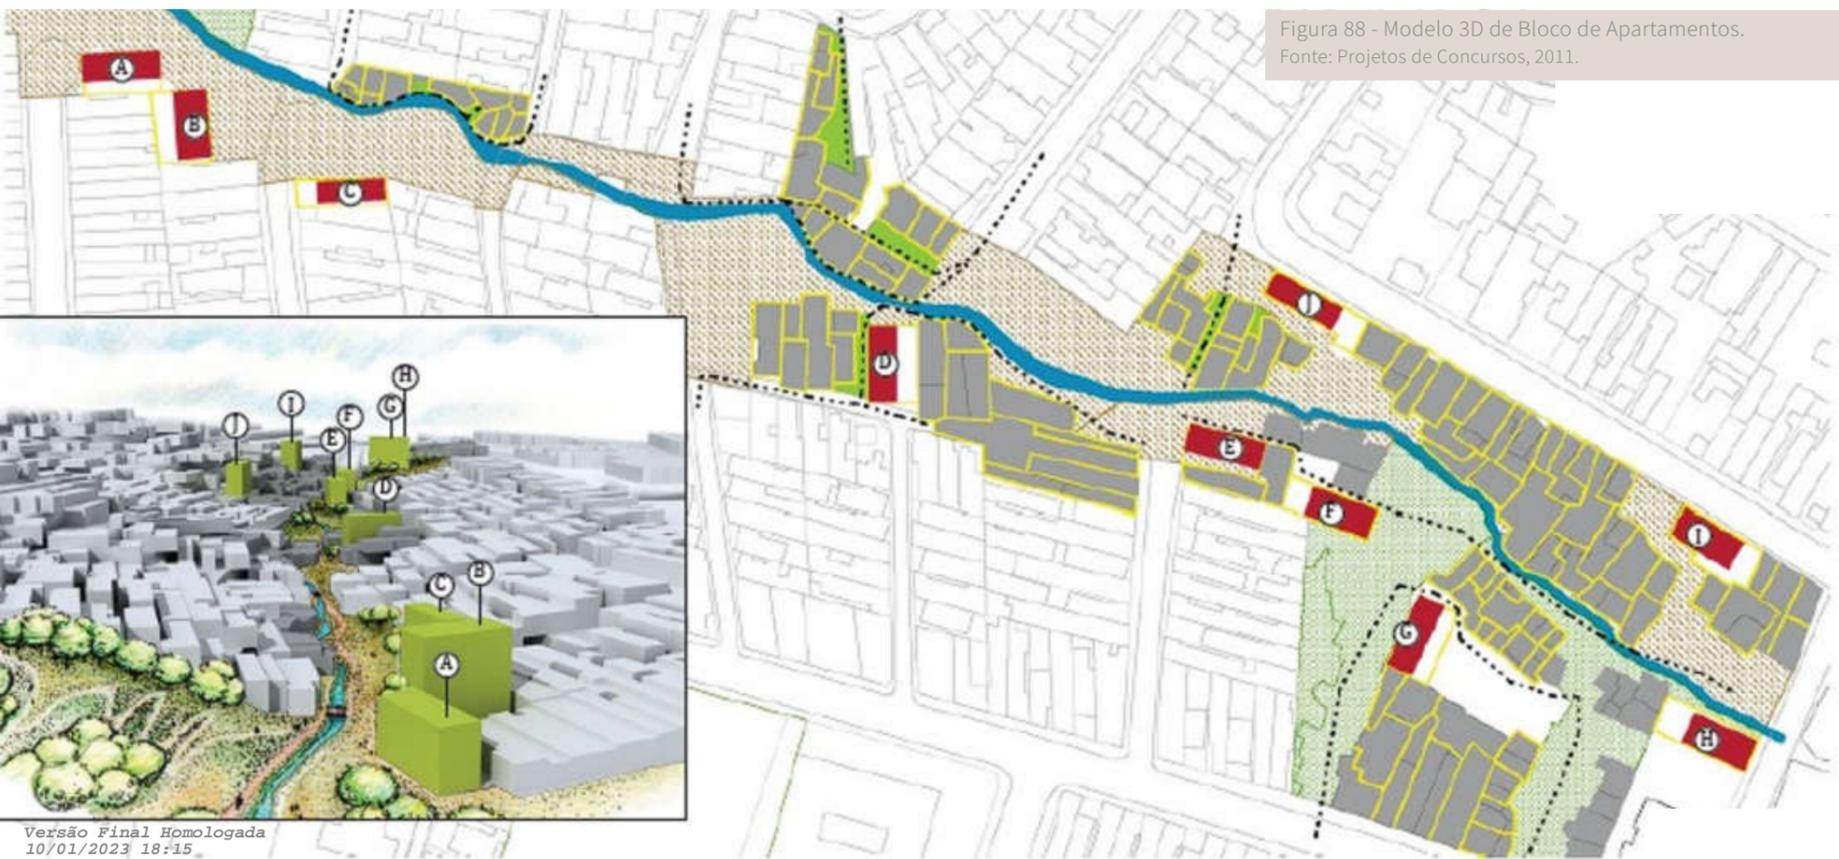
Planta de Localização e Indicações dos Blocos de Apartamentos
